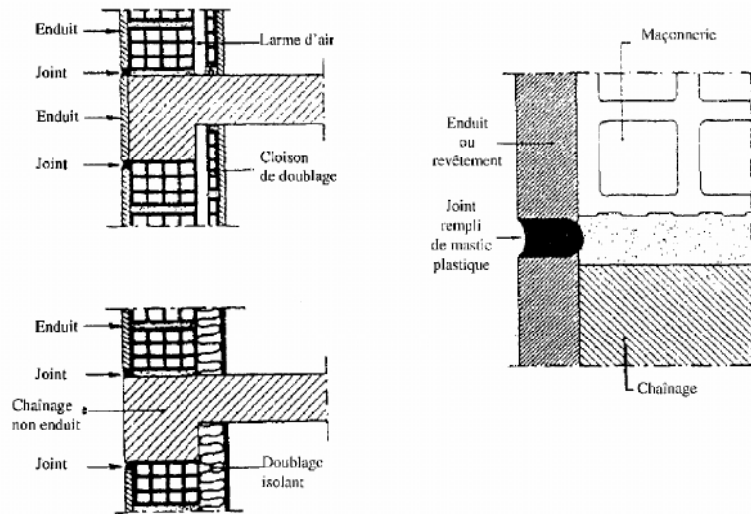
Joint entre la maçonnerie et un chaînage ou linteau en béton armé
